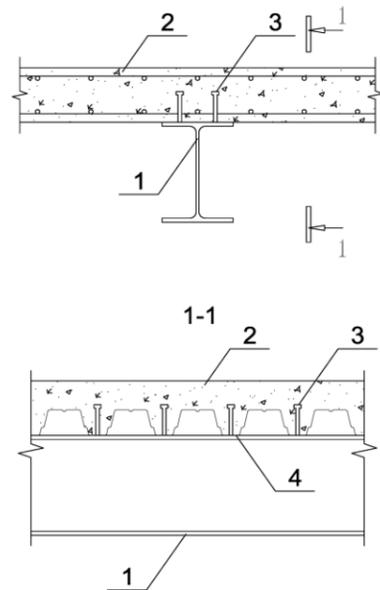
Монолитная плита перекрытия по инвентарной опалубке по верхнему поясу стальной балки; 1 - стальная балка; 2 - монолитное перекрытие; 3 - стальные упоры нагельного типа; 4- профилированный настил
